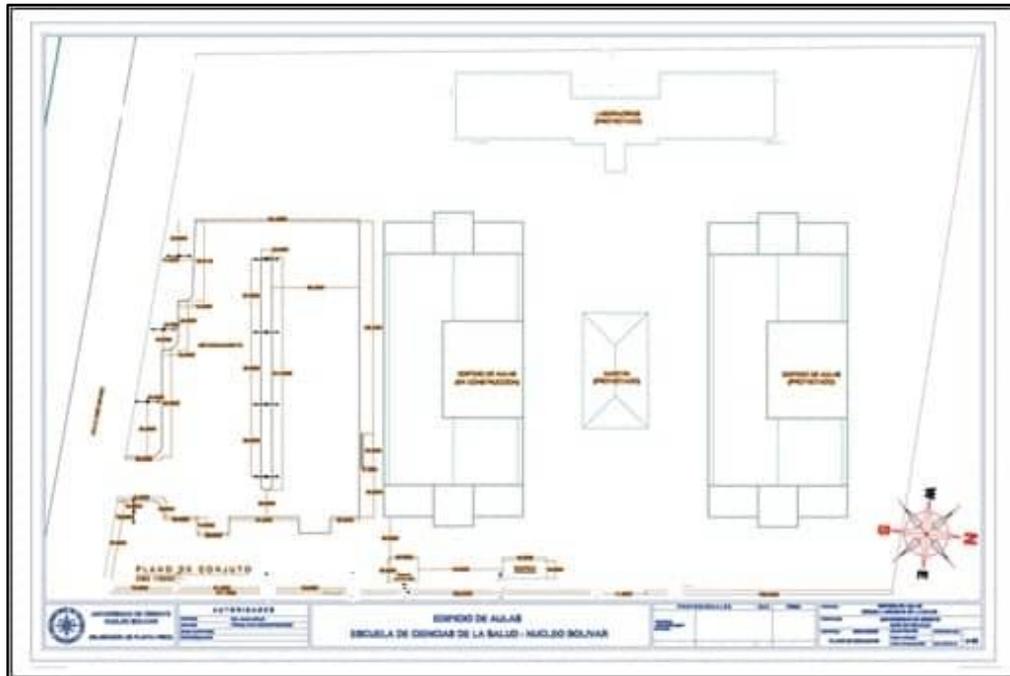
Se muestra el área de trabajo donde se implanta el sistema
